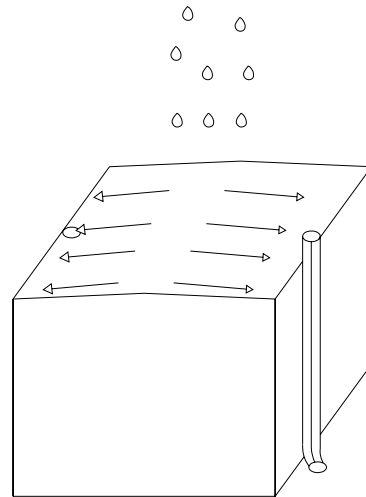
Esquema de losa nivelada, con pendientes hacia las bajadas de agua.
